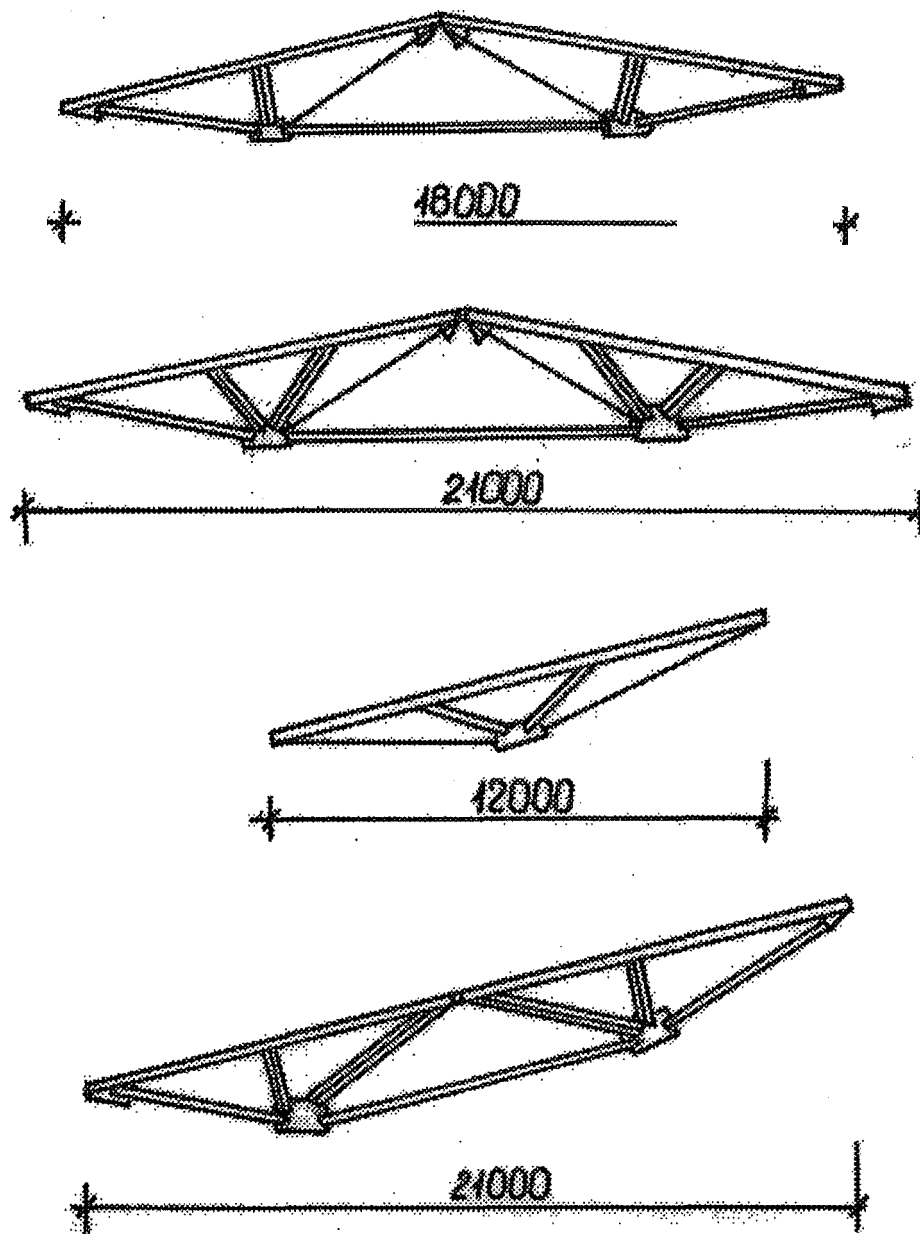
Металлобетонные фермы из гнутосваренных профилей
